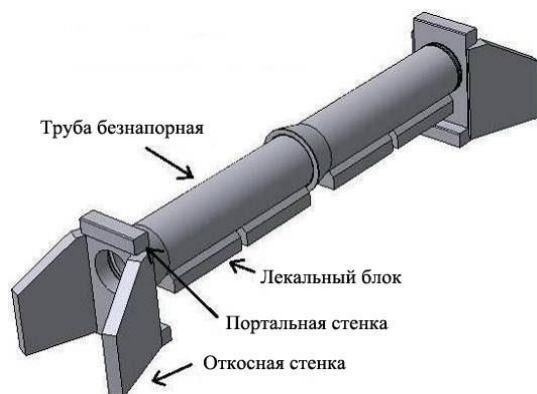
Конструкция круглой водопропускной трубы
